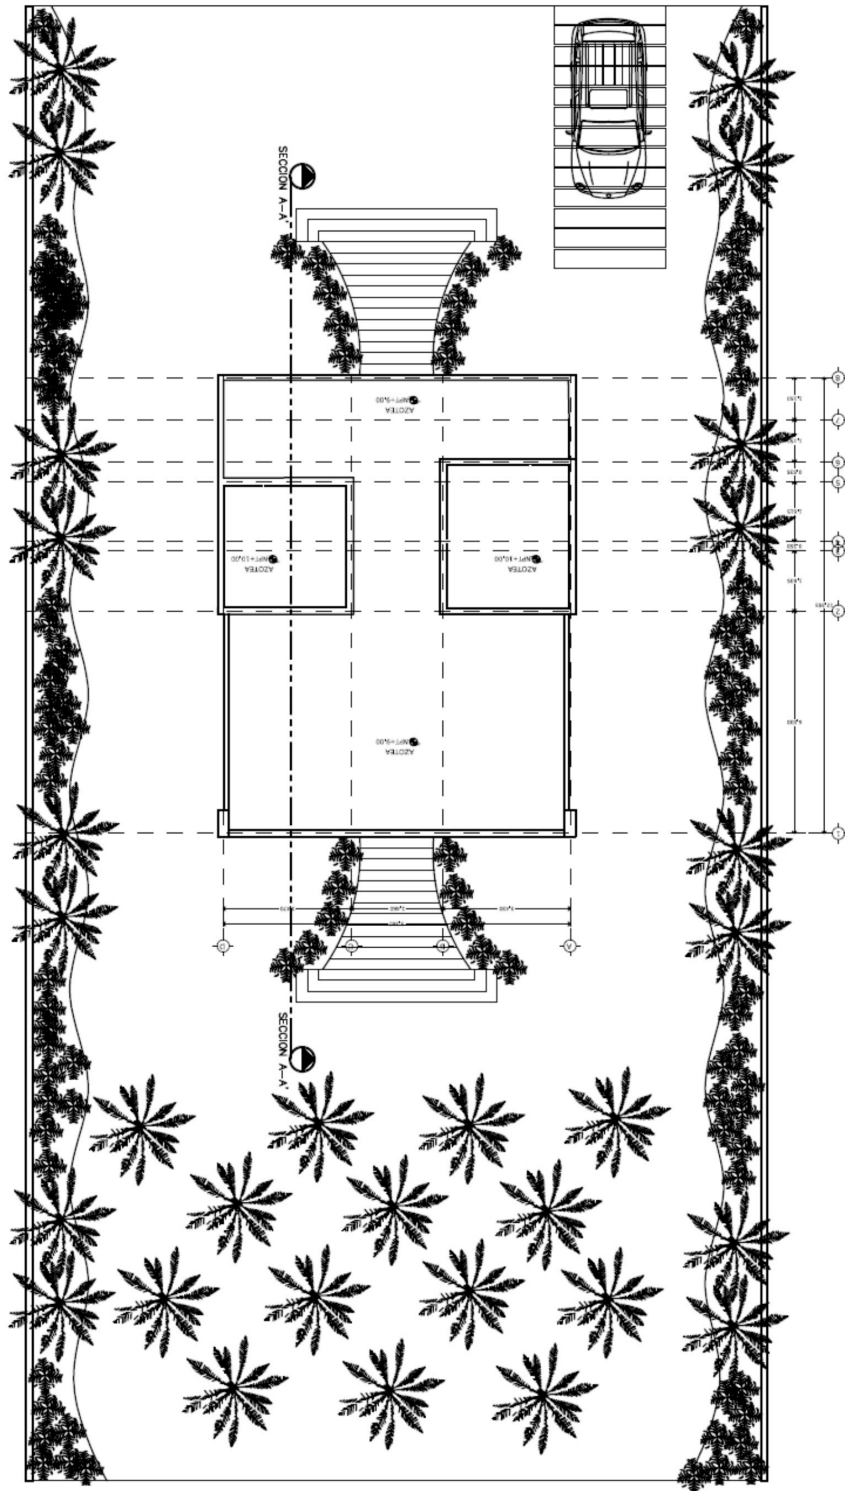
Desplante de la Casa Latam en Planta Baja. El área señalada como terraza de arena será destinada al estacionamiento
